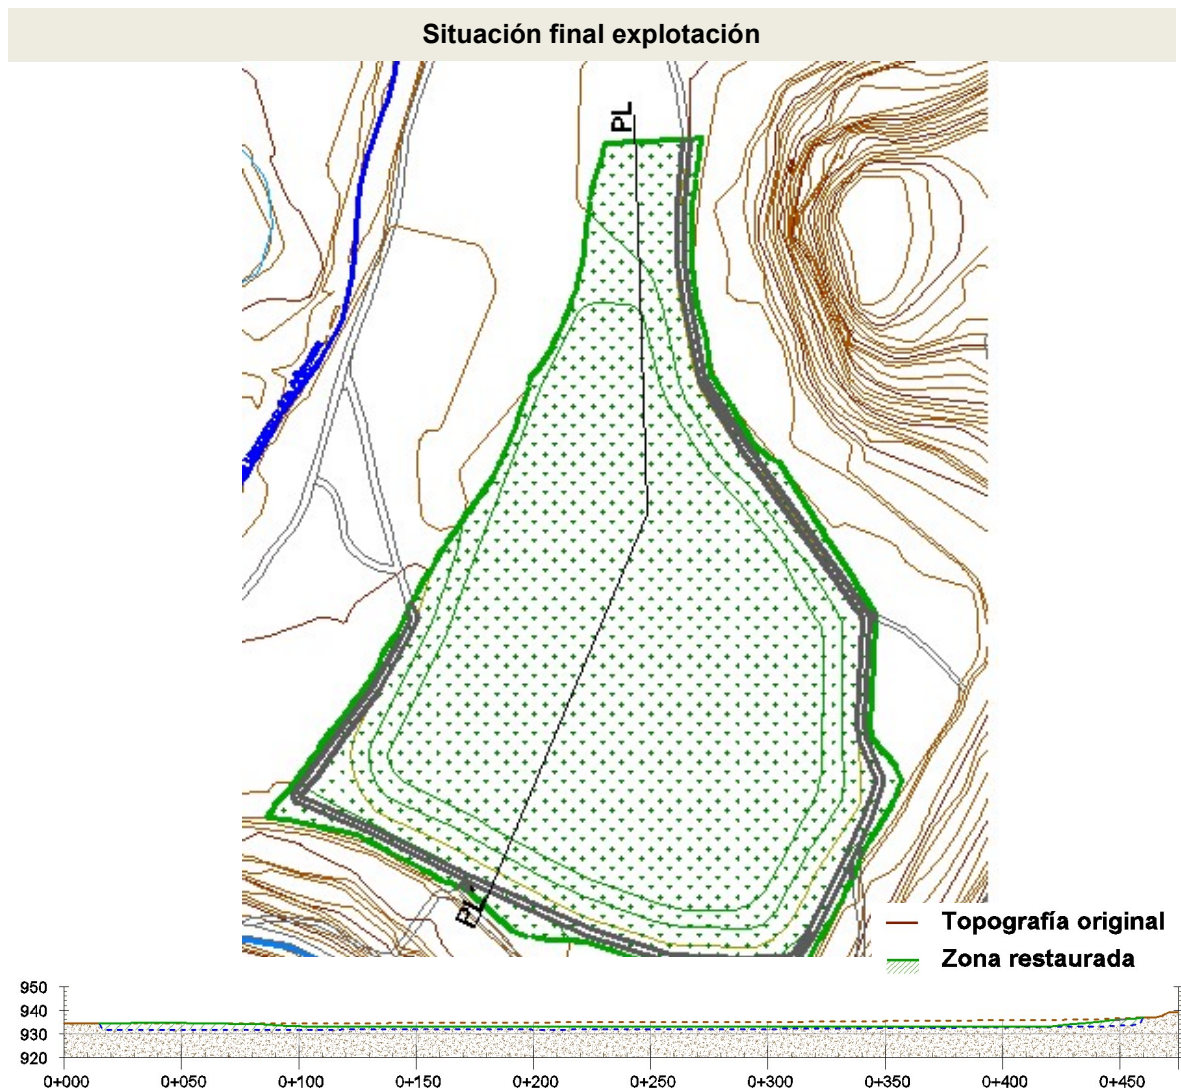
Vista en planta y perfil de situación restaurada
